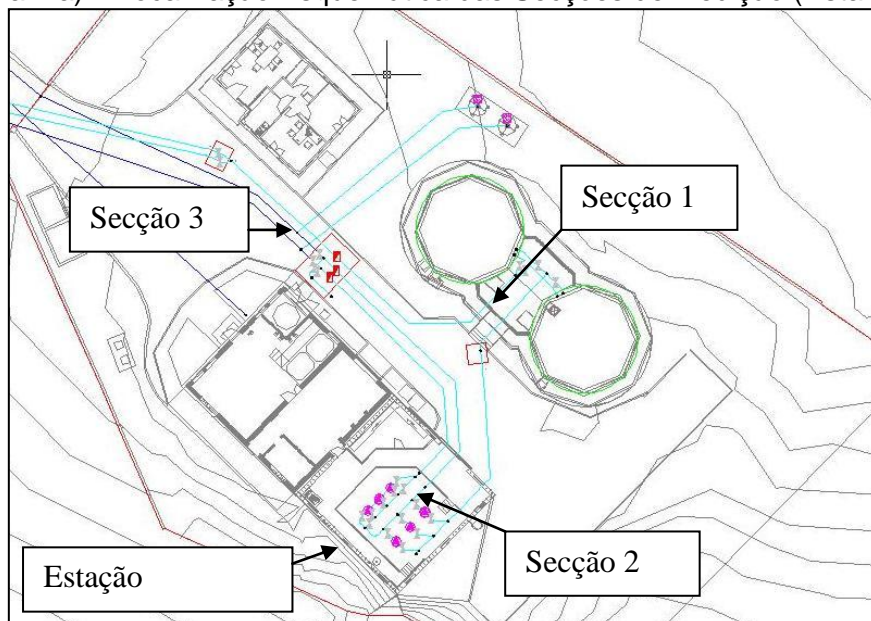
b) – Localização Esquemática das Secções de Medição (vista pormenor da Estação Elevatória)
